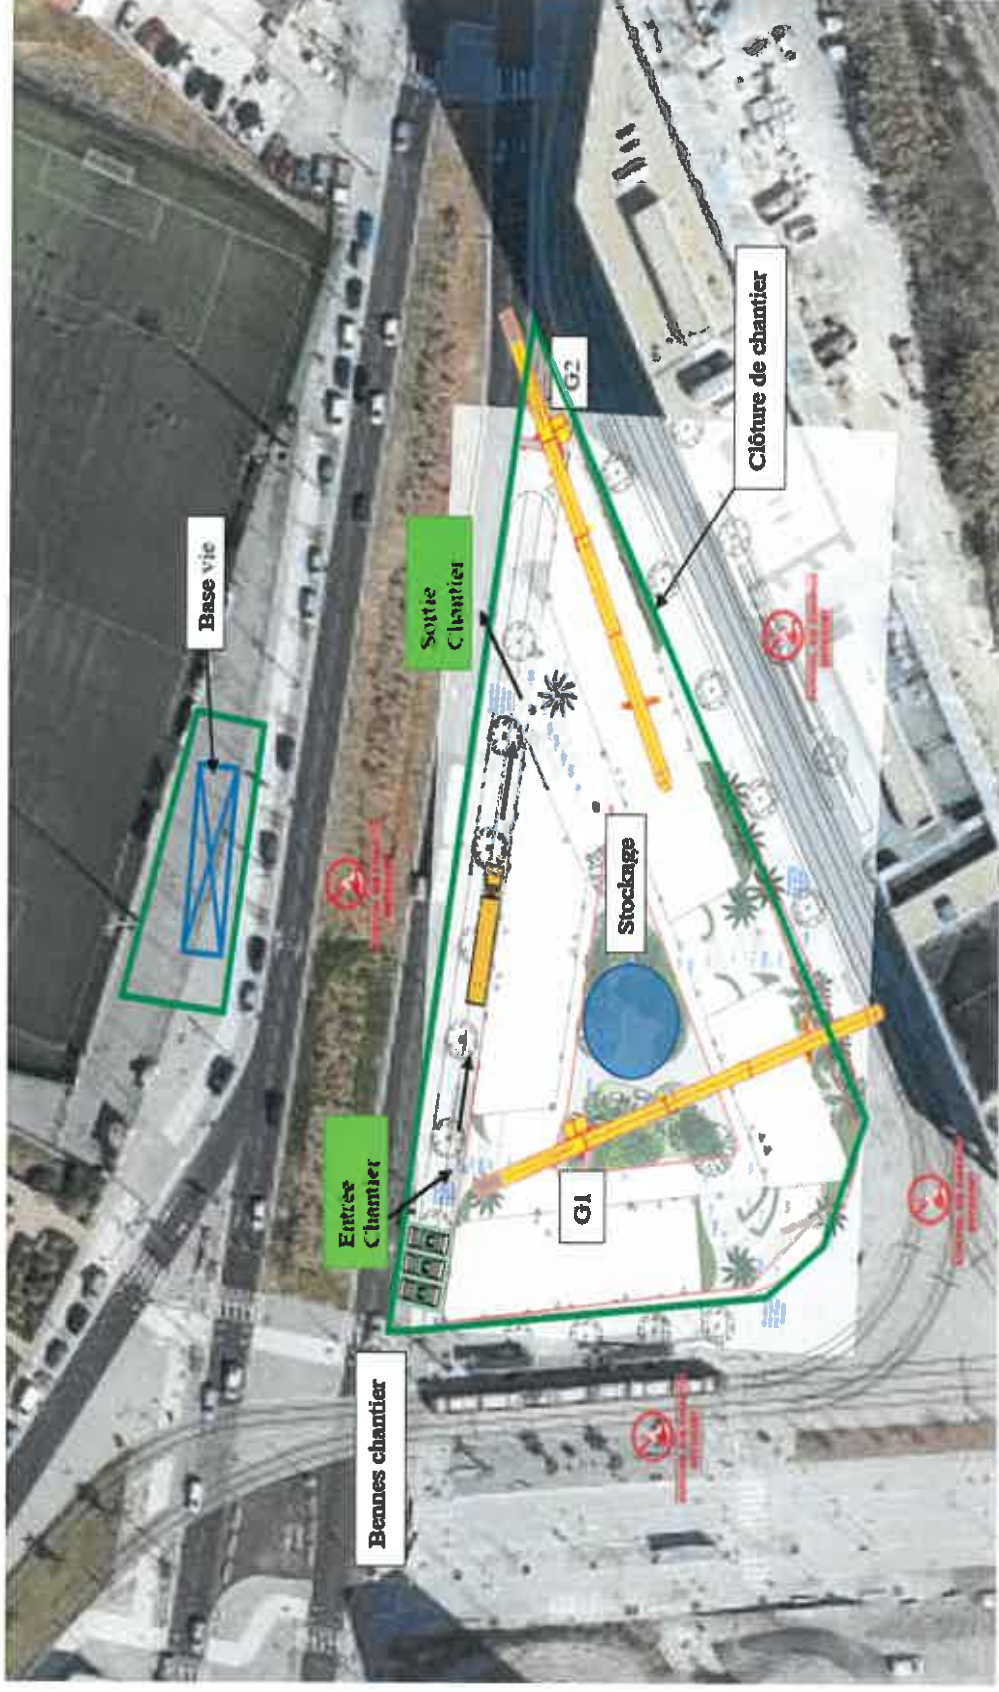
PLAN D'INSTALLATION DU CHANTIER
